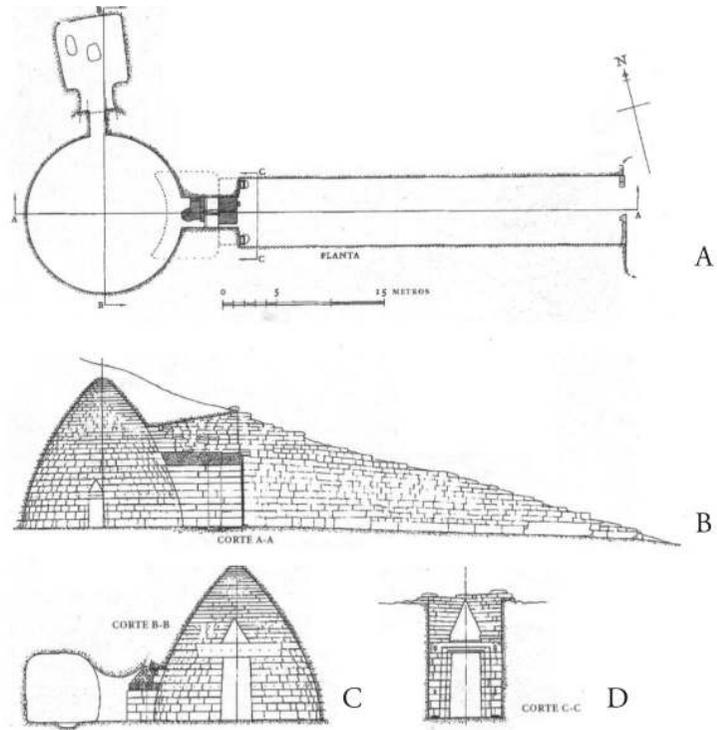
Conjunto de desenhos arquitetônicos do Tesouro de Atreu. Planta baixa (A); Corte longitudinal AA (B); Corte transversal BB (C); Corte CC (D). Túmulo *thólos* em Micenas (c.1300-1250 a.C.) A configuração em planta circular com uma única porta de acesso e cobertura abobadada assemelha-se aos modelos cilíndricos cretenses. Referência iconográfica: LAWRENCE, 1998.
